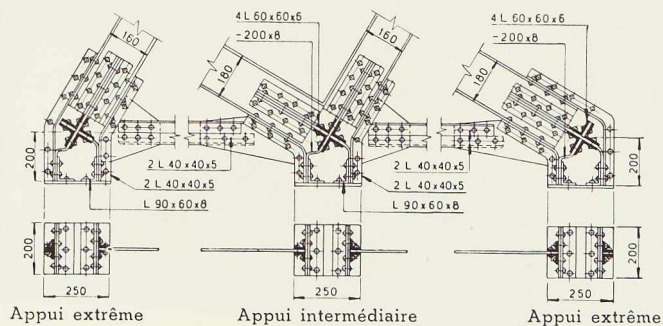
Détail d'appuis de la toiture en shed sur les murs.
